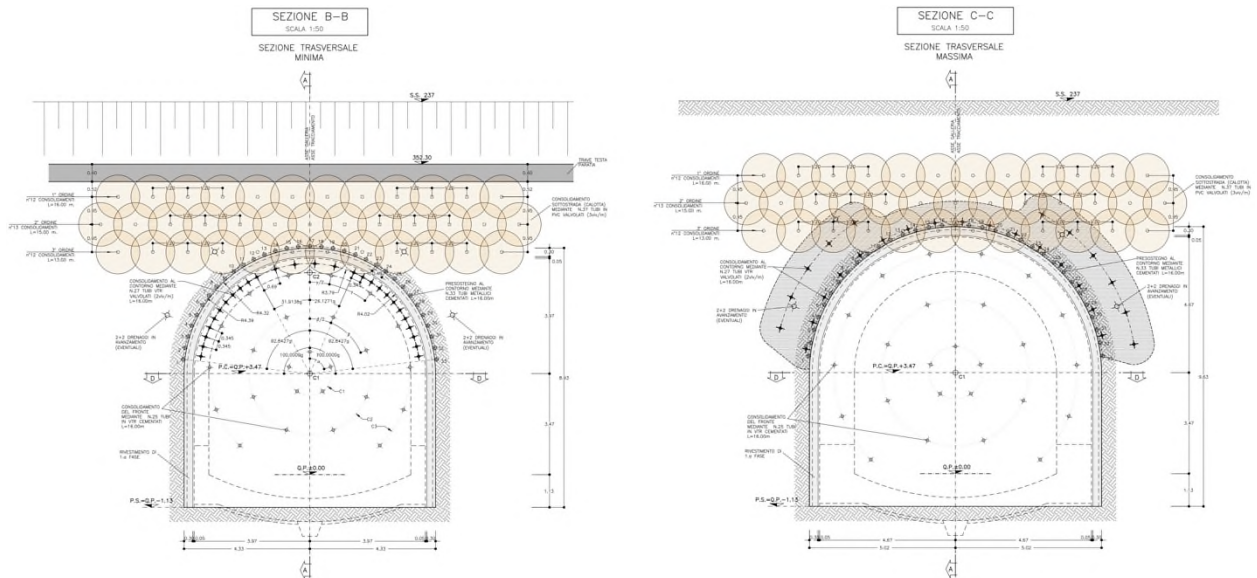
Sezione di Attacco – Scavi e consolidamenti - Sezione
